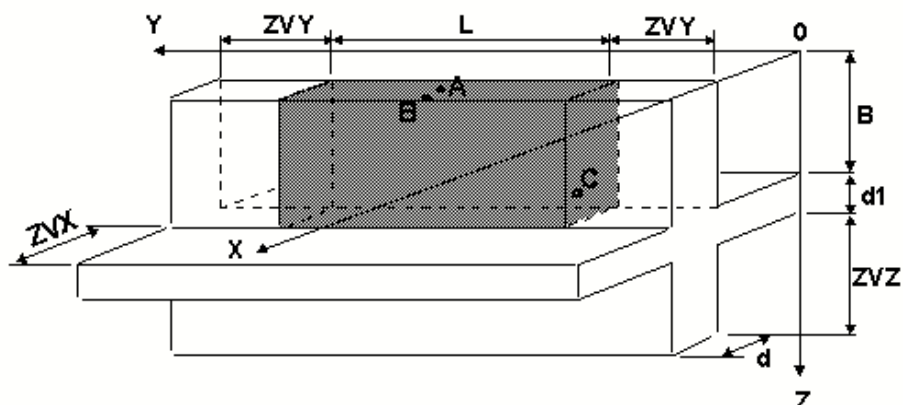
Расчётная схема бетонирования фрагмента стены
